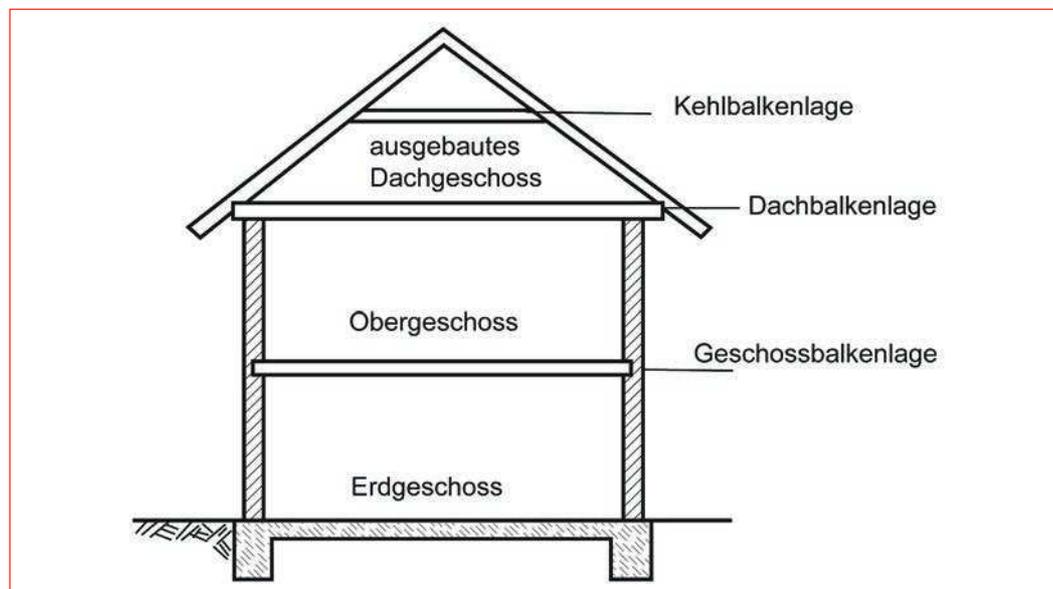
Benennung der Balkenlagen im Gebäude
